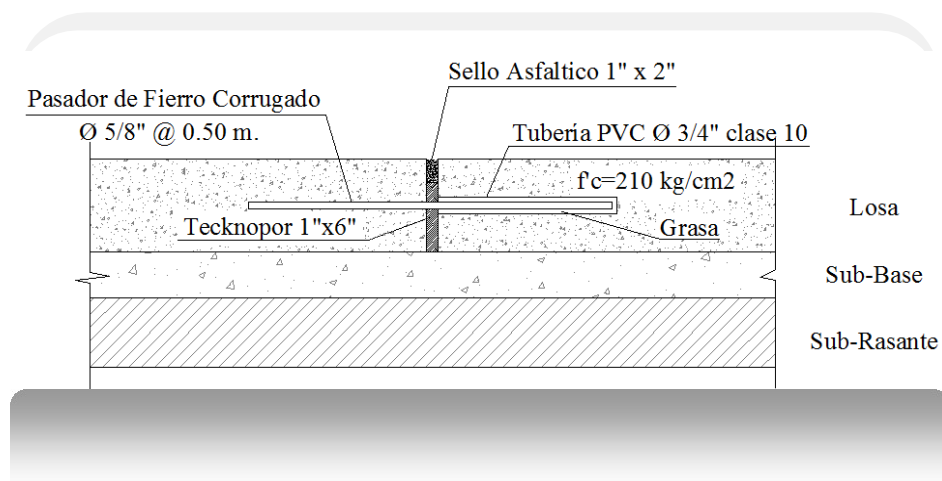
Diseño de paquete estructural de un pavimento rígido.
